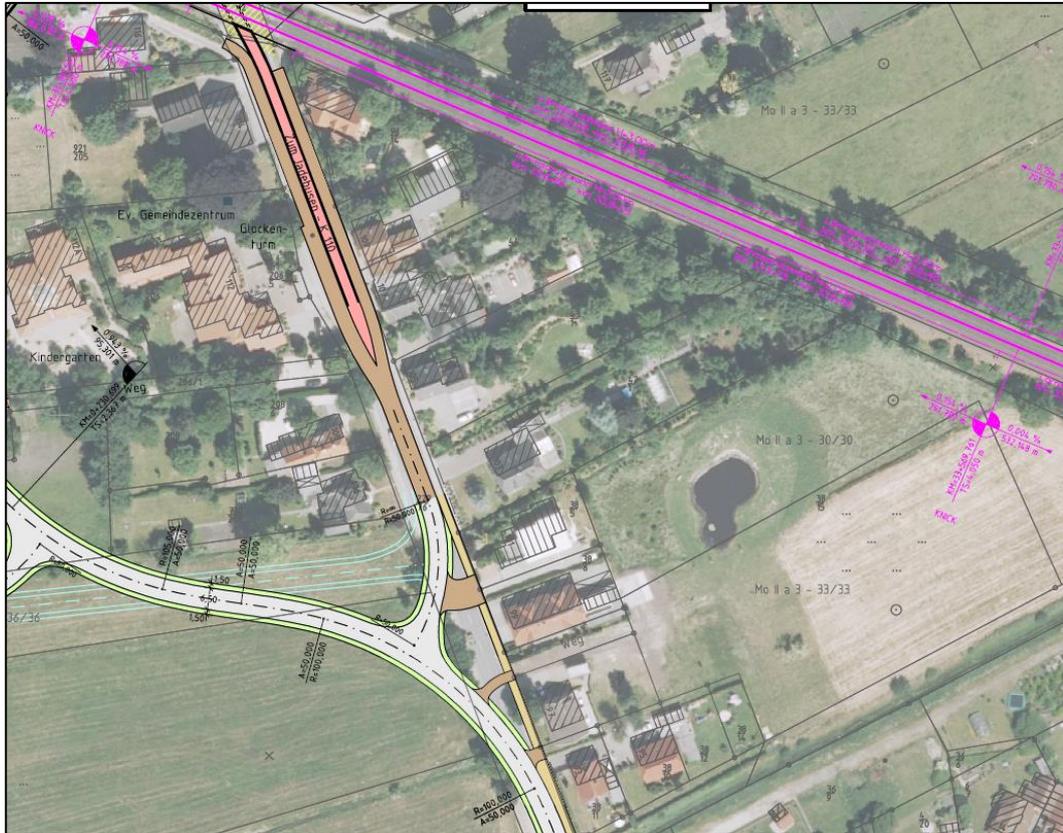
Ausschnitt aus Auffassung BÜ 31 Zum Jadebusen, Variante 6, Neubau Eisenbahnführung, Stand: 12/10 (Quelle: Stadt Varel)
